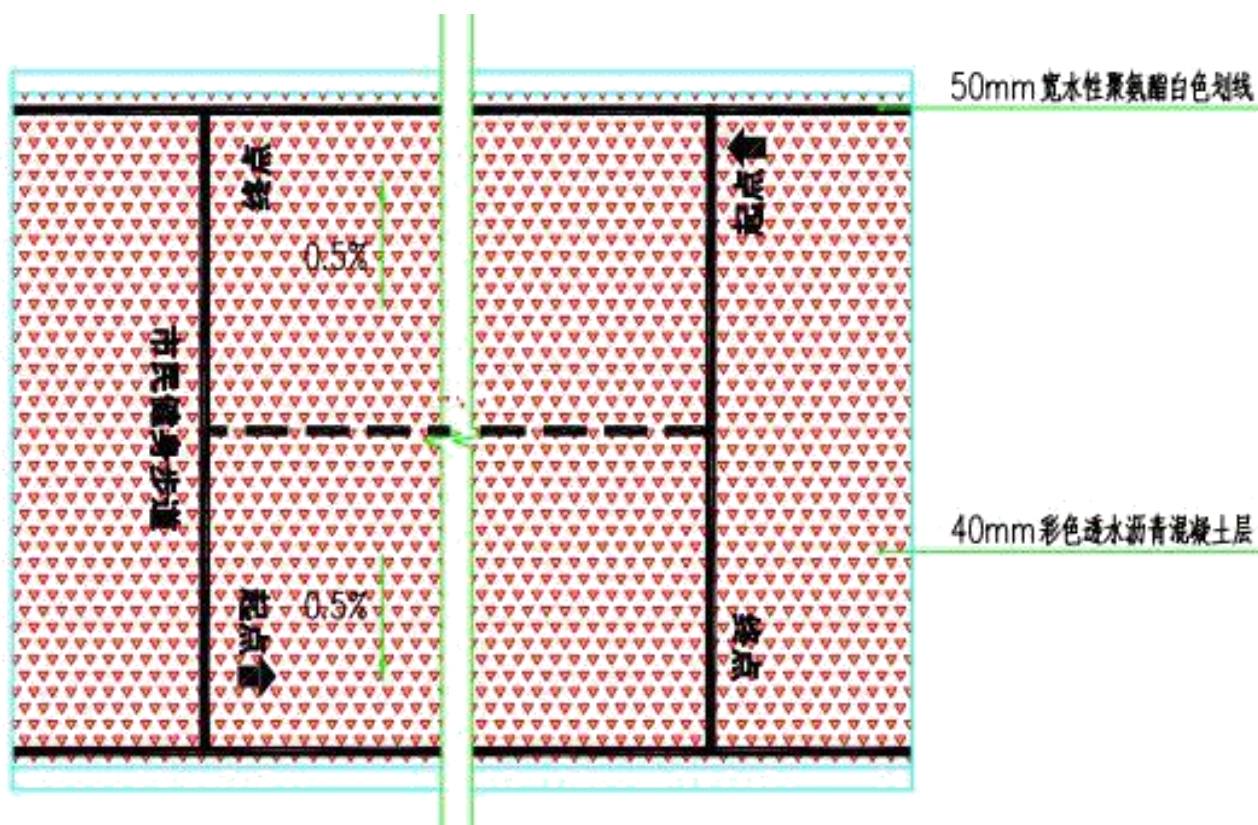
彩色沥青混凝土健身步道参考剖面图（单向）
